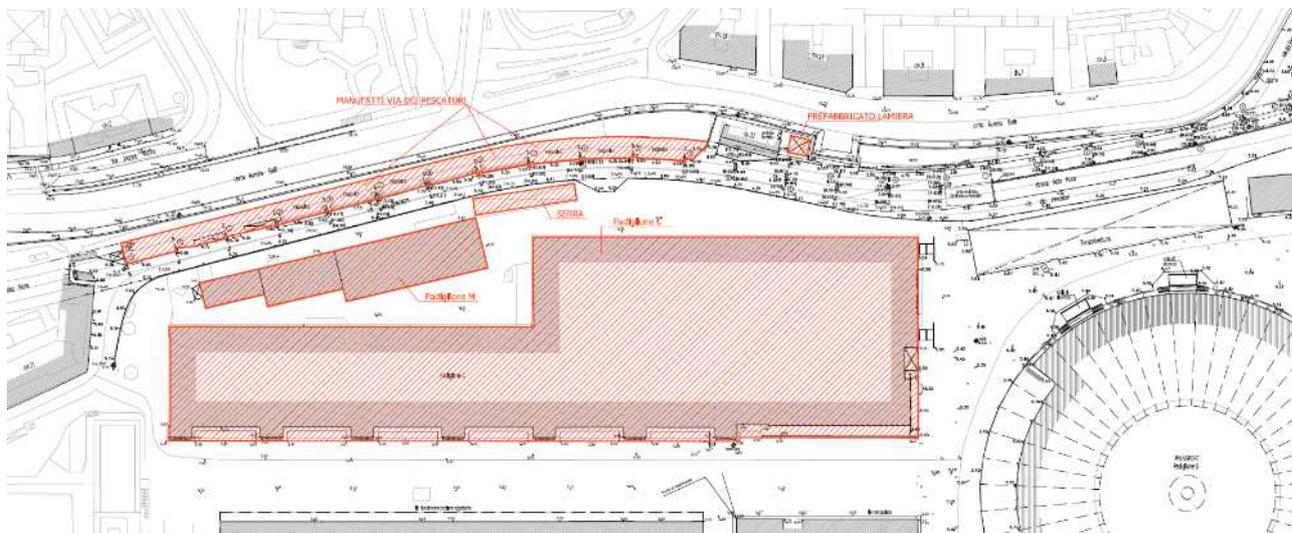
Stralcio planimetria degli interventi di demolizione. Da PFTI infrastrutture mobilità e parcheggio MOGE 20411
